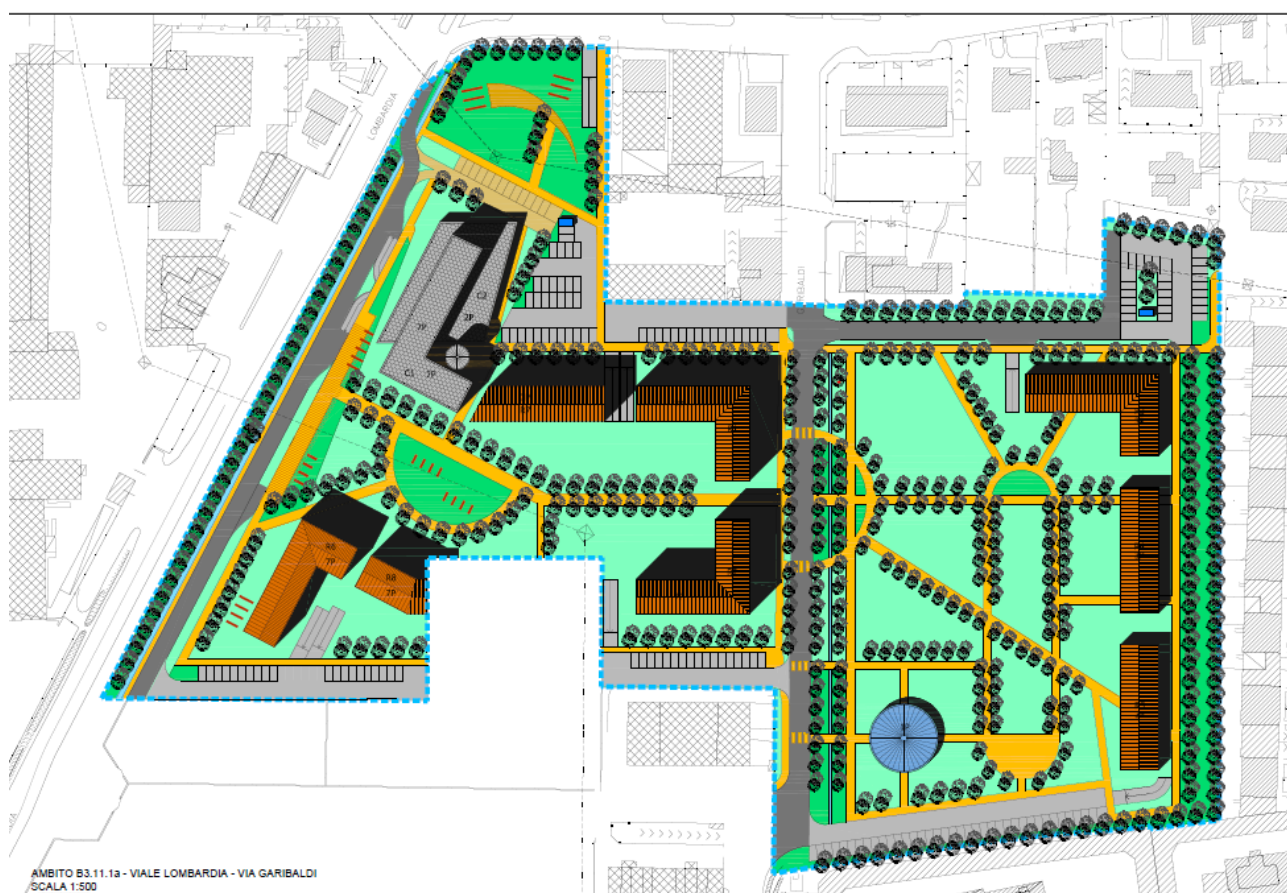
planivolumetrico PII vigente - ambito viale Lombardia
